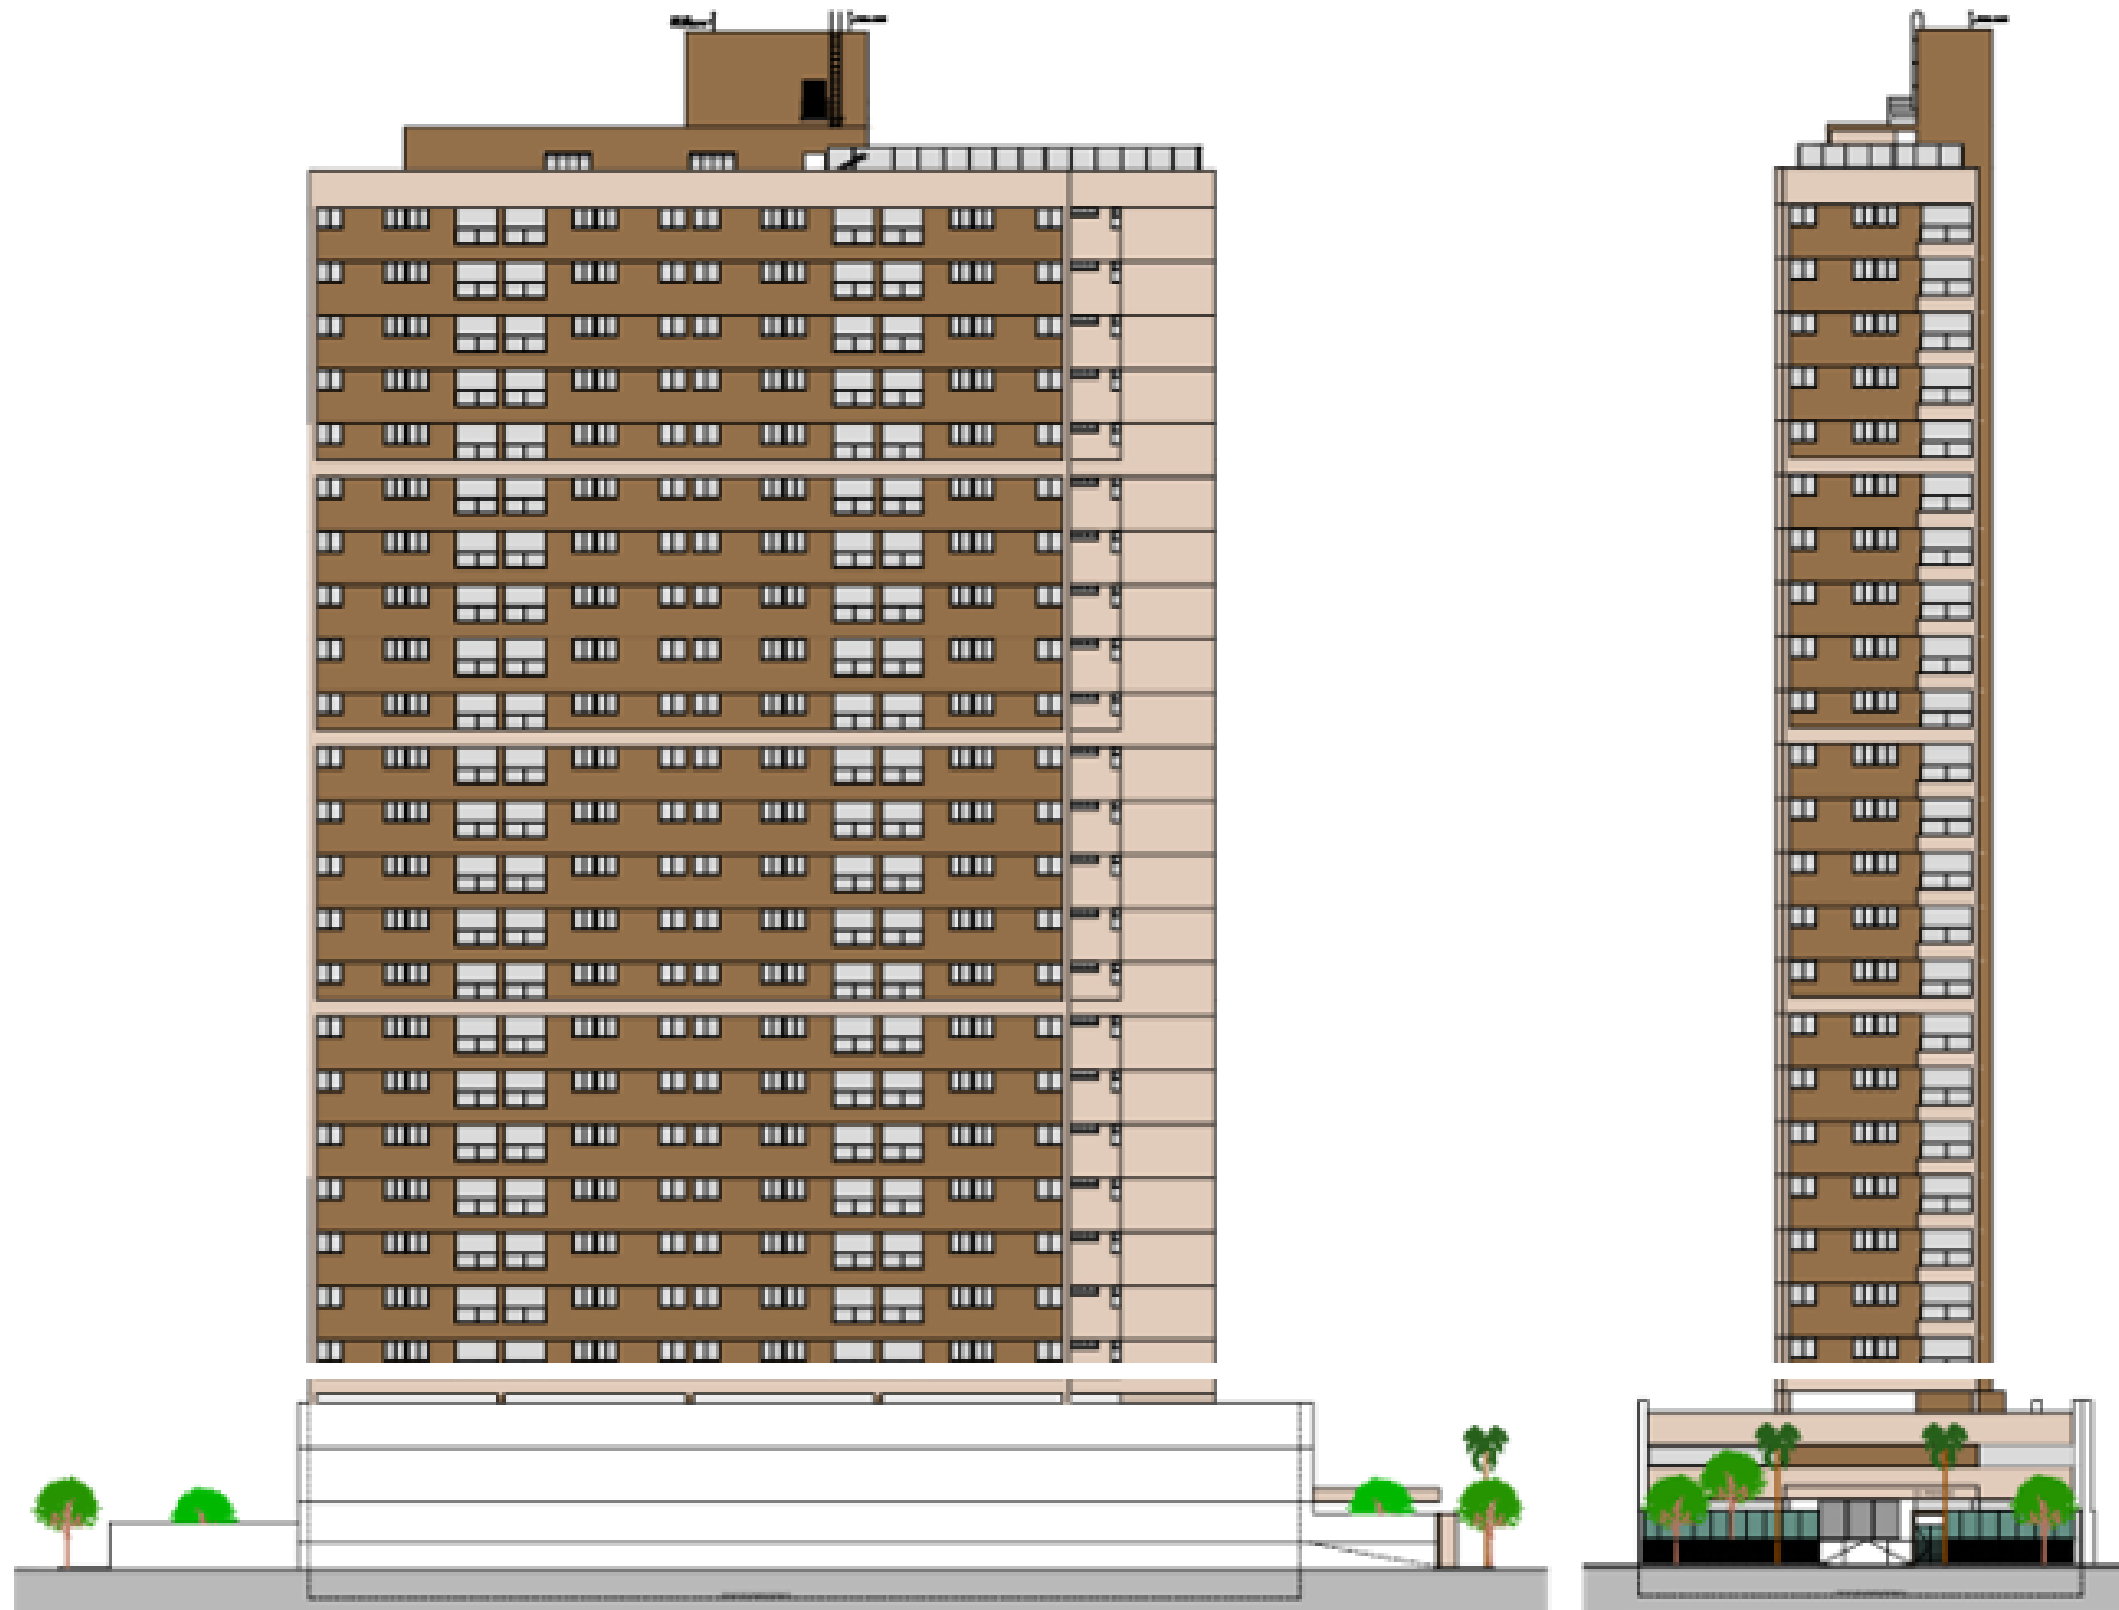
FACHADAS SUL E LESTE P12.13 –
